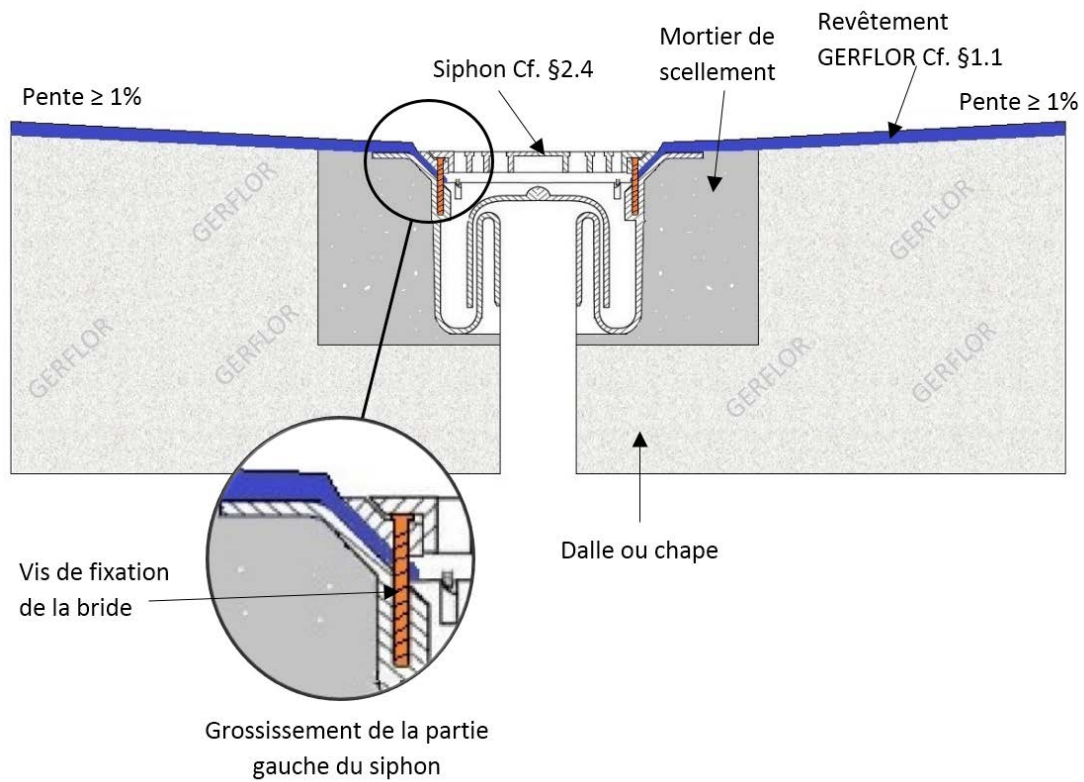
Exemple de traitement de raccordement au siphon sur chape ou dalle adhérente à base de liants hydrauliques (enduit de sol non représenté)
